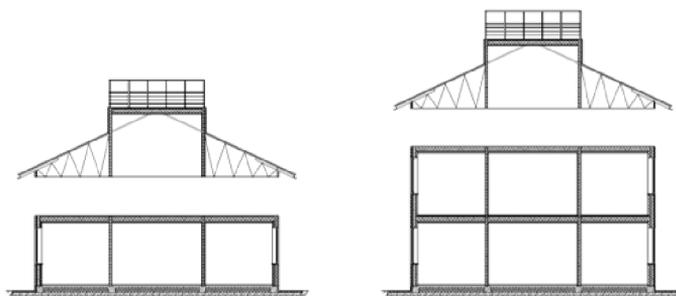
Схема демонтажа кровли с одноэтажного здания и монтаж на двухэтажное
